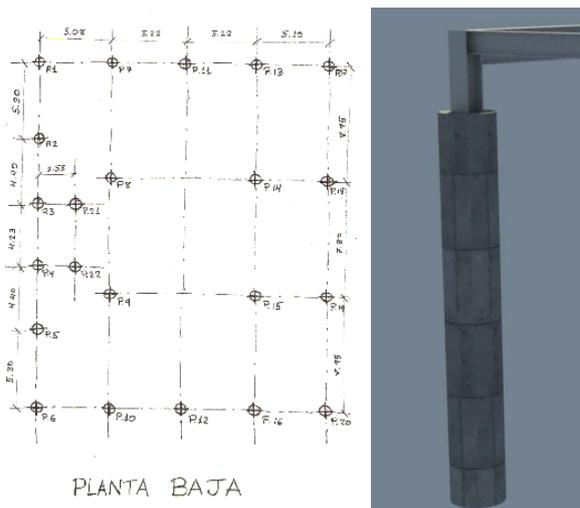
Croquis de cuadrícula de pilares Planta baja y animación de pilar tipo, Allplan. (Elaboración propia).
